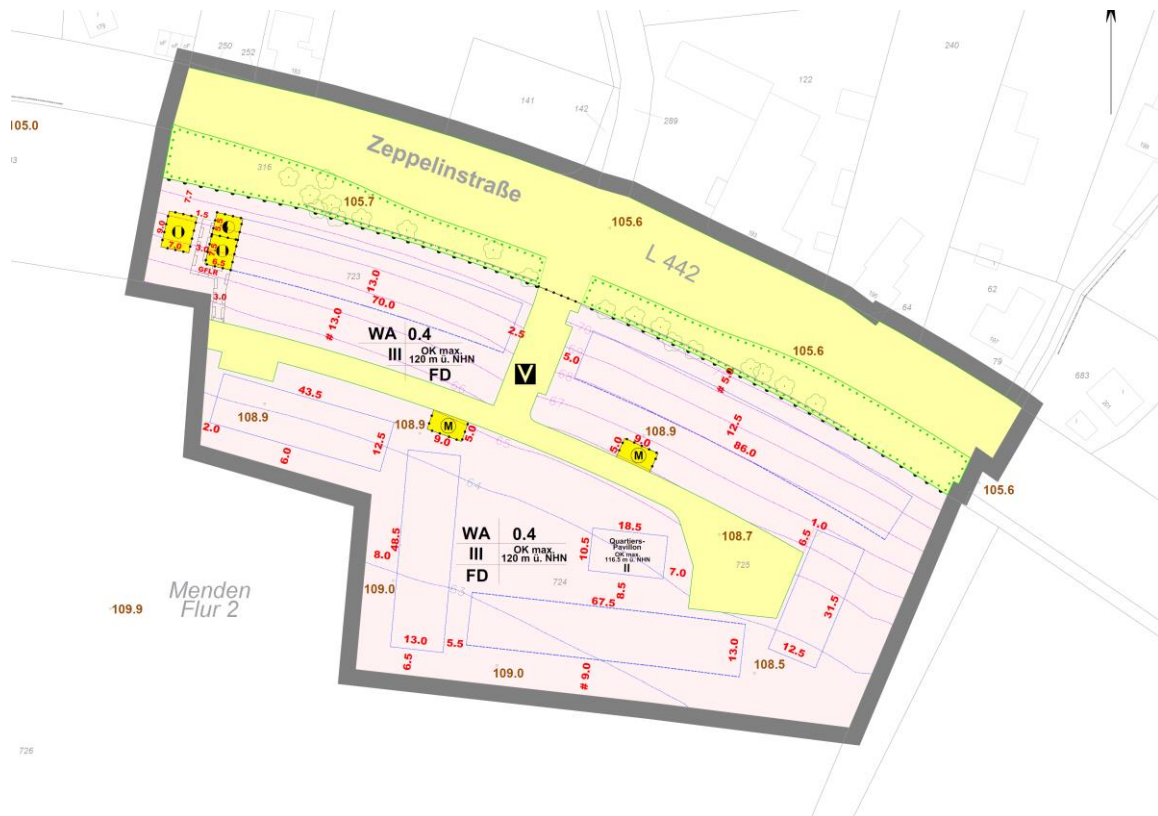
Auszug aus dem Bebauungsplan „Zeppelinstraße/ ehemalige Stadtgärtnerei - H 21“ der Stadt Mülheim an der Ruhr (Stand 23.10.2024)
